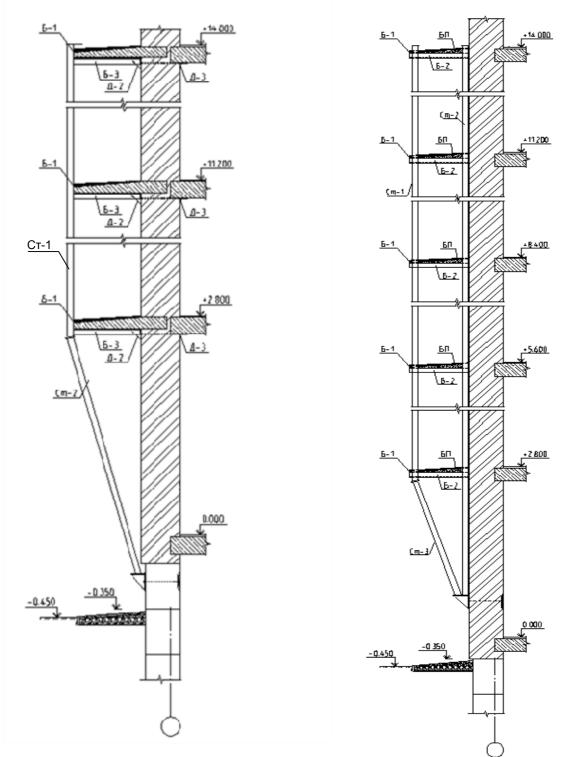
Усиление вертикального ряда балконных плит а) с помощью стоек, закрепленных на консоль в уровне фундаментных блоков, б) с помощью стоек, опирающихся на консоль, закрепленную на кирпичной стене
